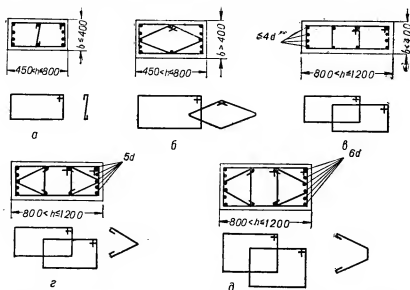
95. Армирование колонн хомутами и конструктивной продольной арматурой:
